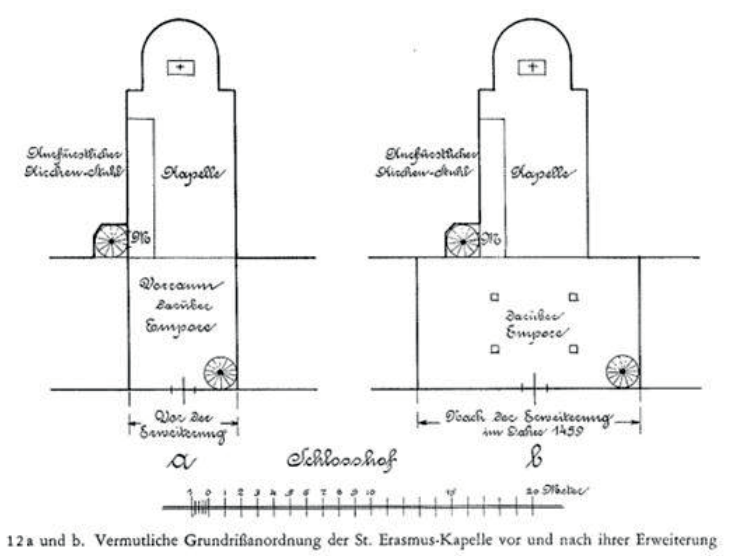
Grundrisse vor und nach Erweiterung erster Erasmuskapelle, aus Albert Geyer „Geschichte des Berliner Schlosses“
